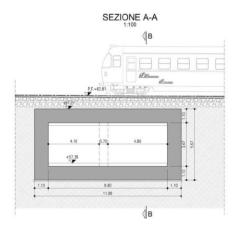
Planimetria e sezione dell'attraversamento in progetto
